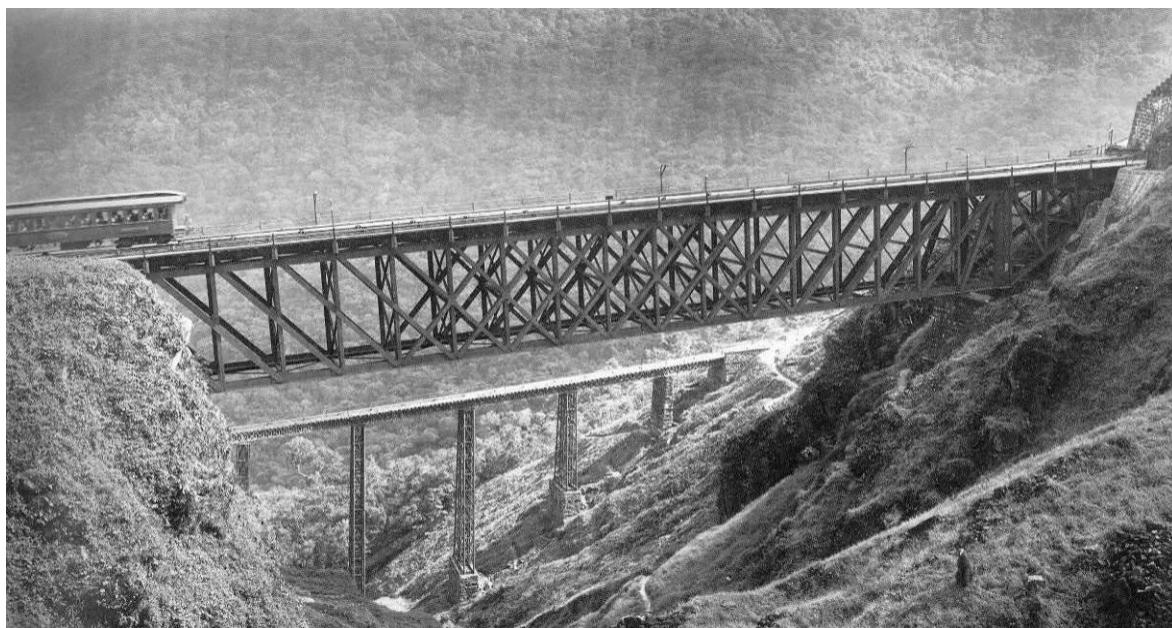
Grotta Funda. Em primeiro plano o viaduto do primeiro sistema funicular, na forma de uma estrutura metálica treliçada, e aos fundos o do segundo sistema, com tabuleiro inclinado e apoiado sobre pilares em ferro e base em alvenaria. Fonte: *Ibid.
